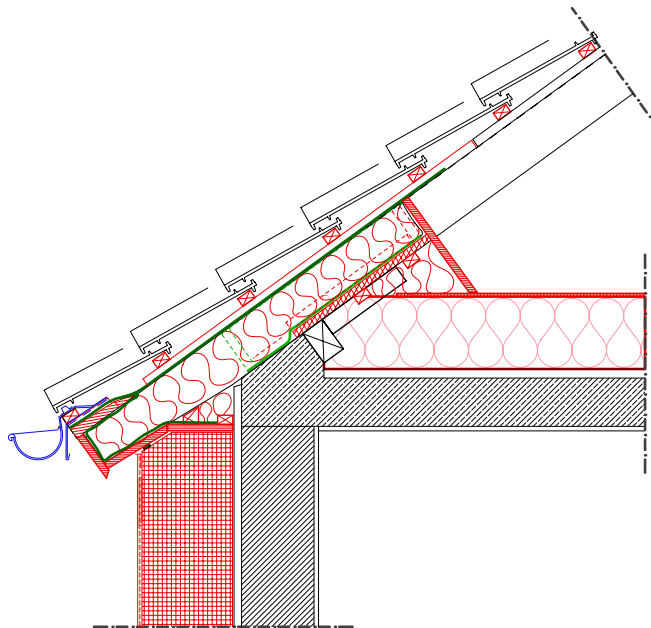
Beispieldetail oberste Geschossdecke und Anschluss an Fassade ndämmung, ohne Maßstab, bauart Architekten
